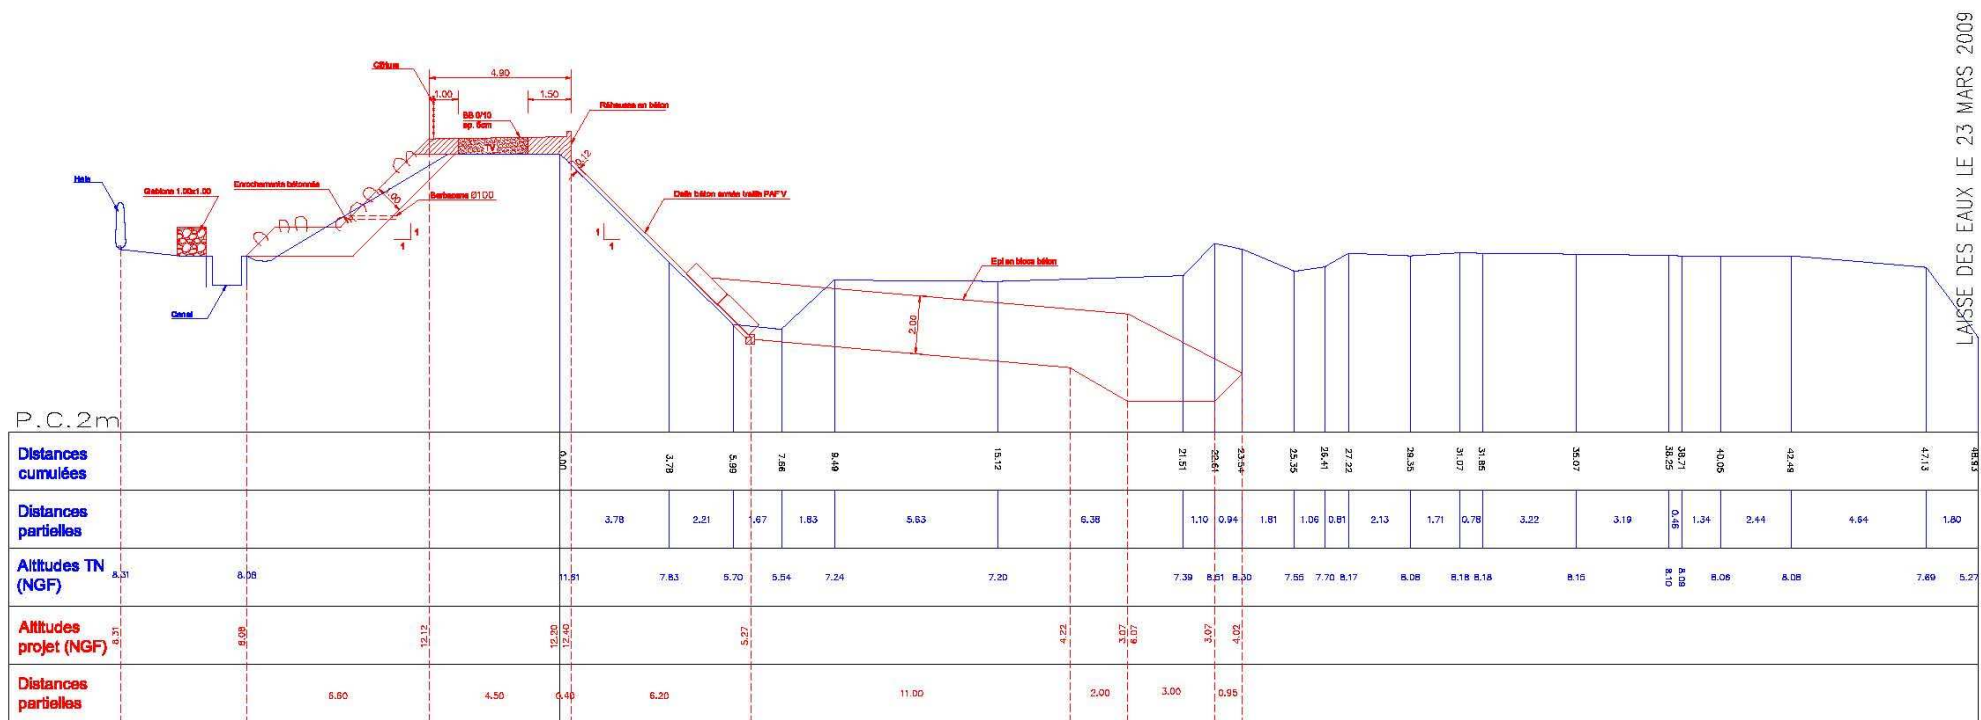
Profil en travers du projet de la digue (source CG 04/2009)
